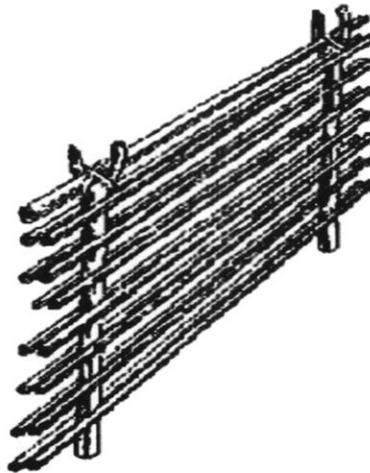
Amarre de varas de carrizo en paredes de bahareque.
